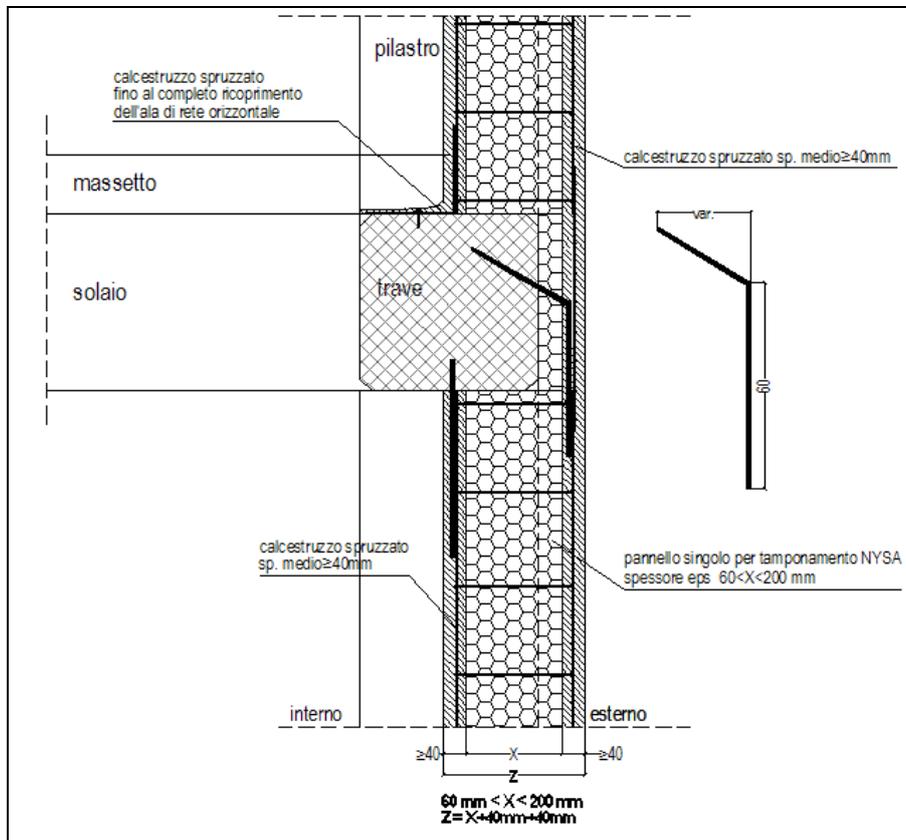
Fasi 3 e 4 - -Caso B: sezione verticale del collegamento.
